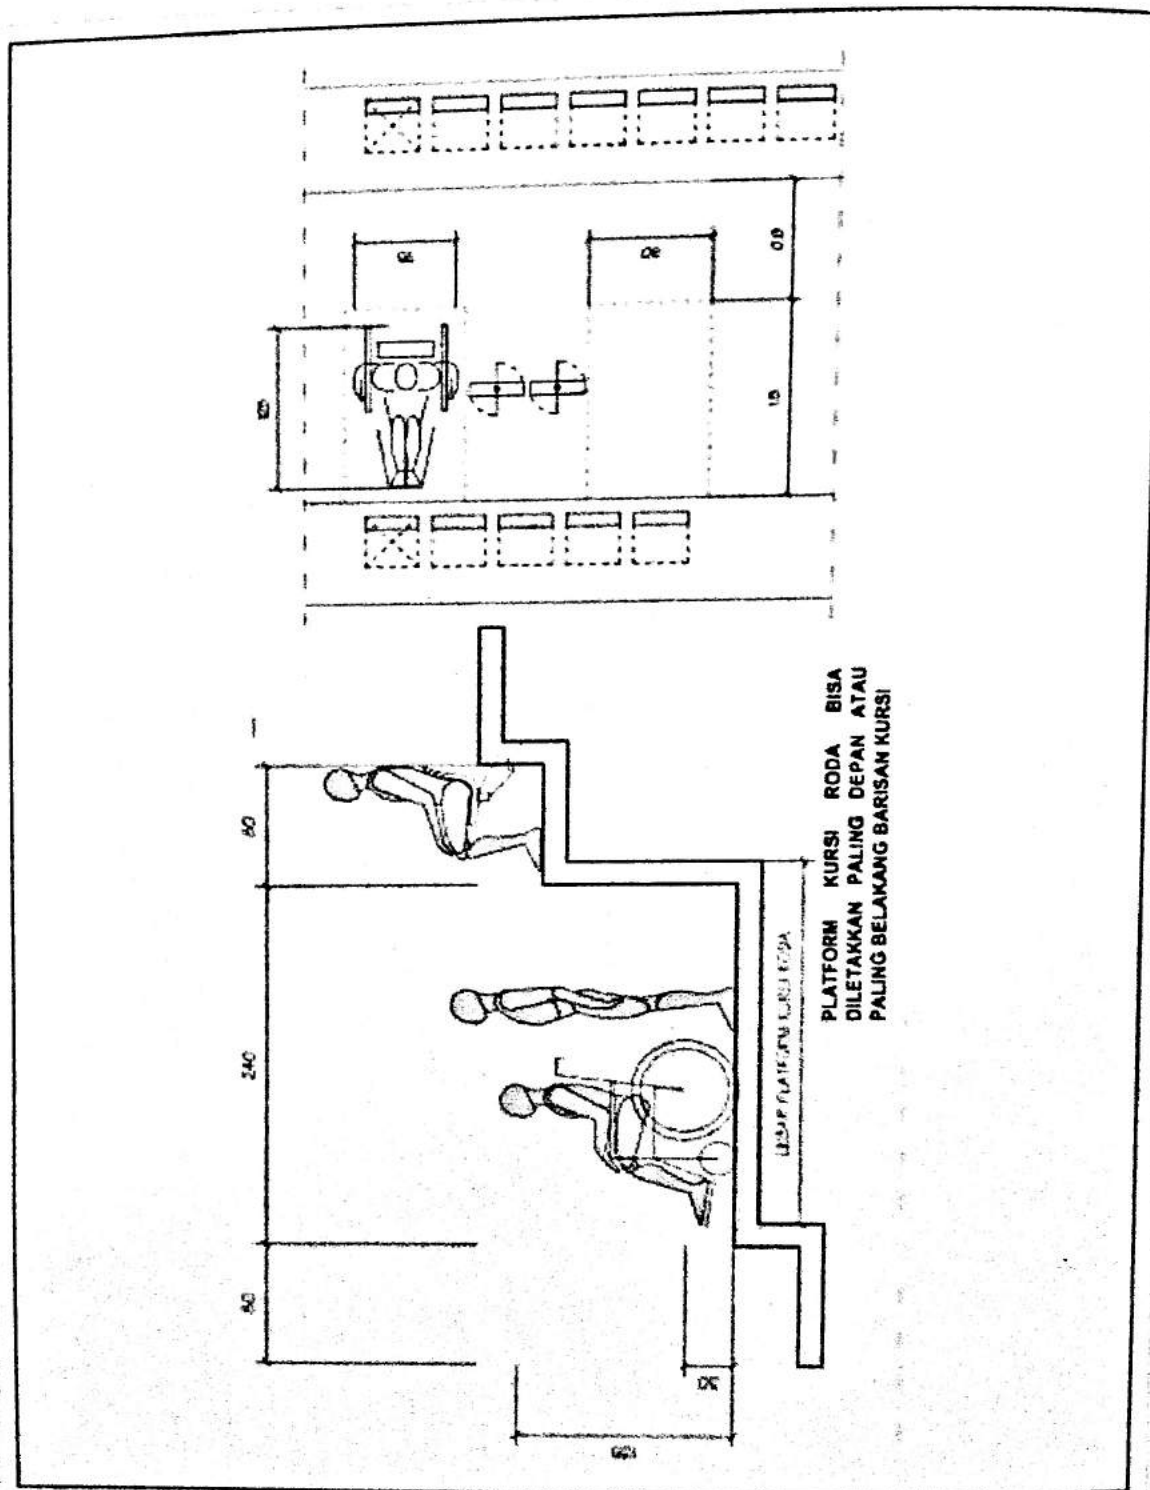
Denah garis pandangan penonton pada di Tribun ke Arena
